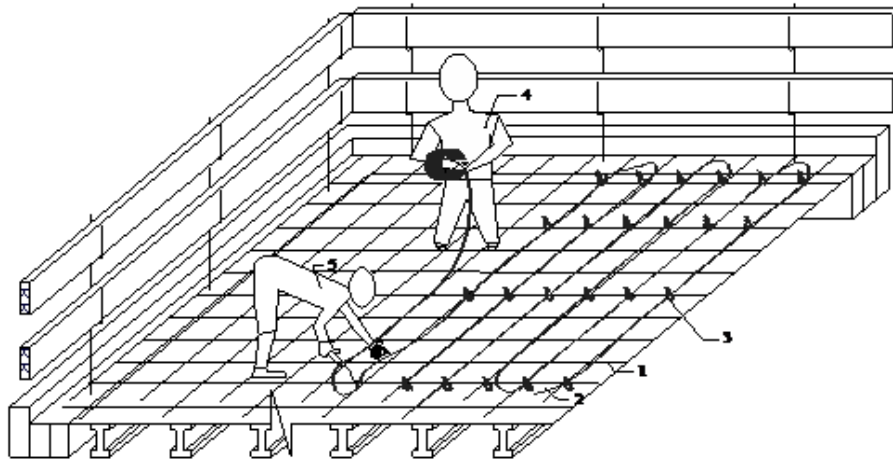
Схема укладки греющего провода: 1 стержень арматурной сетки;
